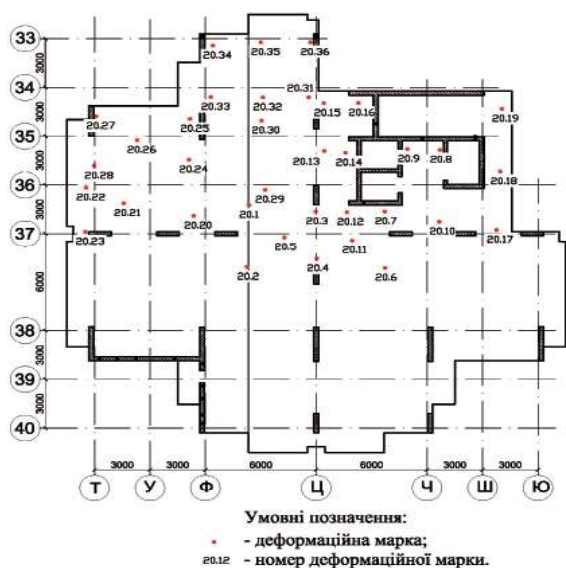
Результати спостережень вертикальних переміщень перекриття 20-го поверху будівлі
